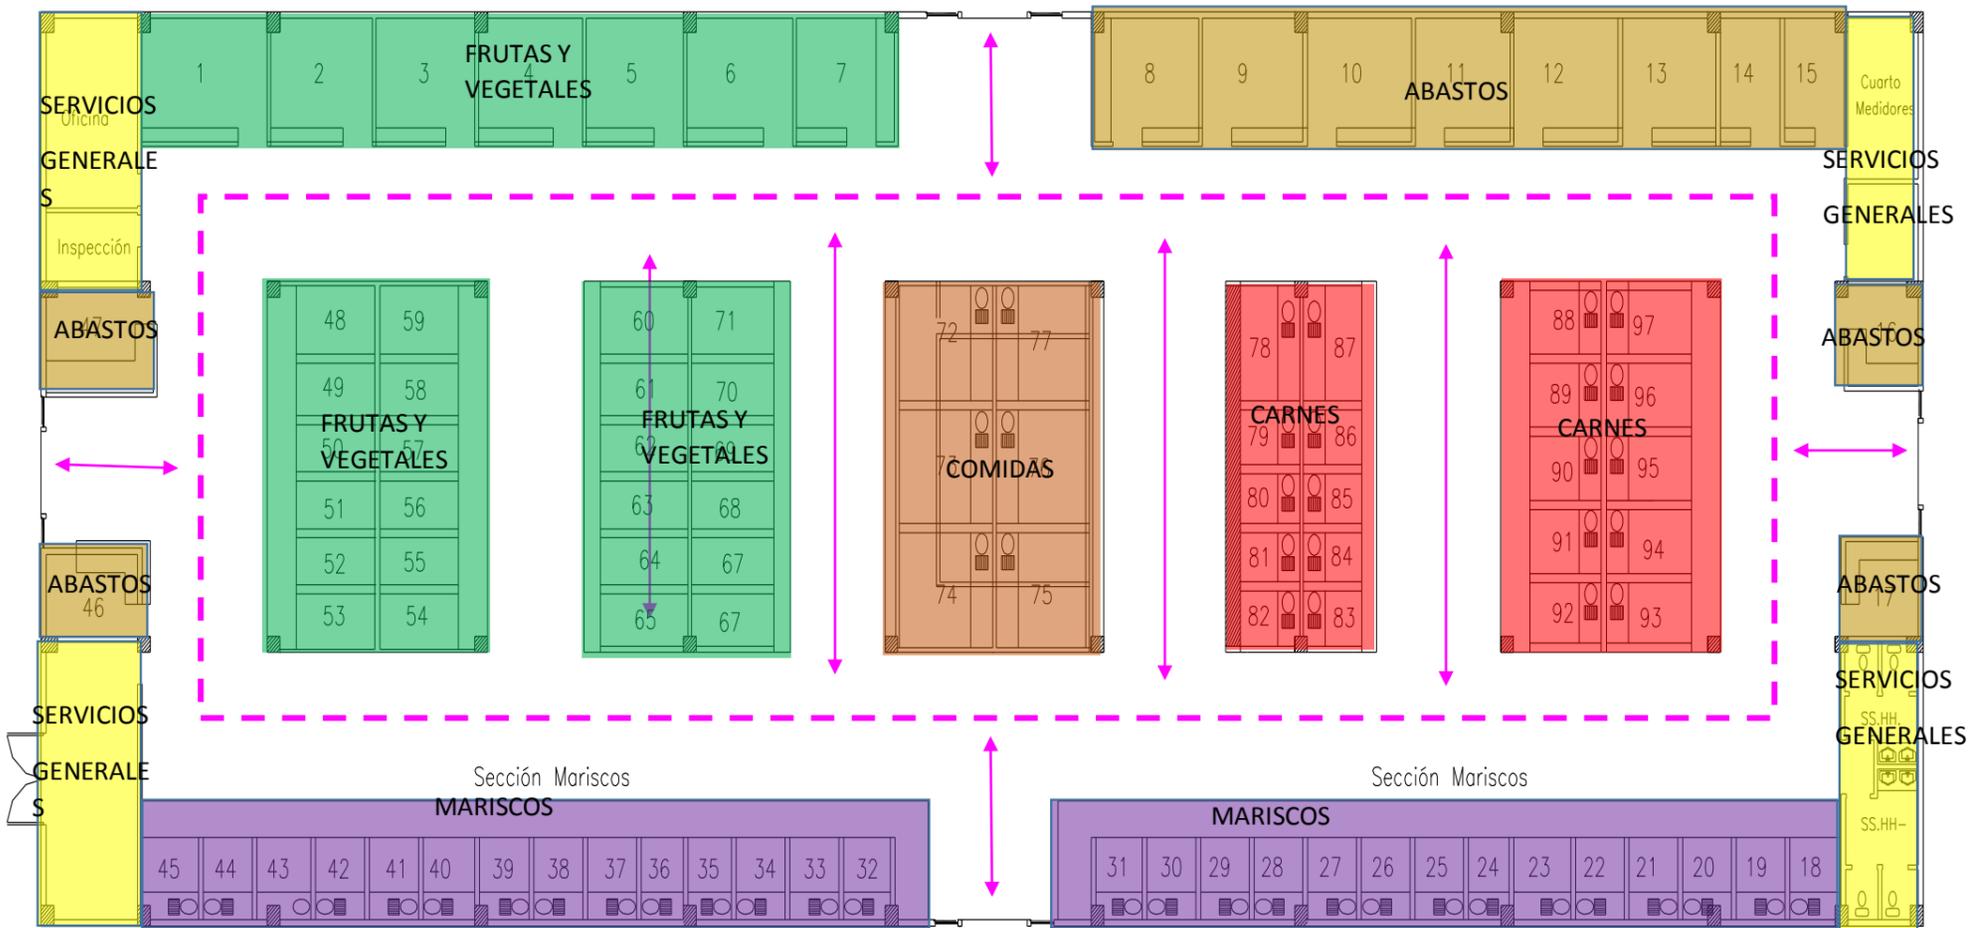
planta arquitectónica tipología 2 (Rivadeneira, 2014)
